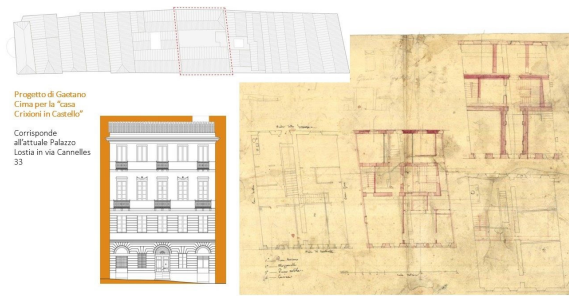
Progetto per la Casa Grixioni in Castello (corrispondente all'attuale Palazzo Lostia in via Cannelles 33): progetto originale Gaetano Cima, rappresentazione planimetrica e del prospetto Laura Brandinu (fonte: Cuboni et al. 2016).
